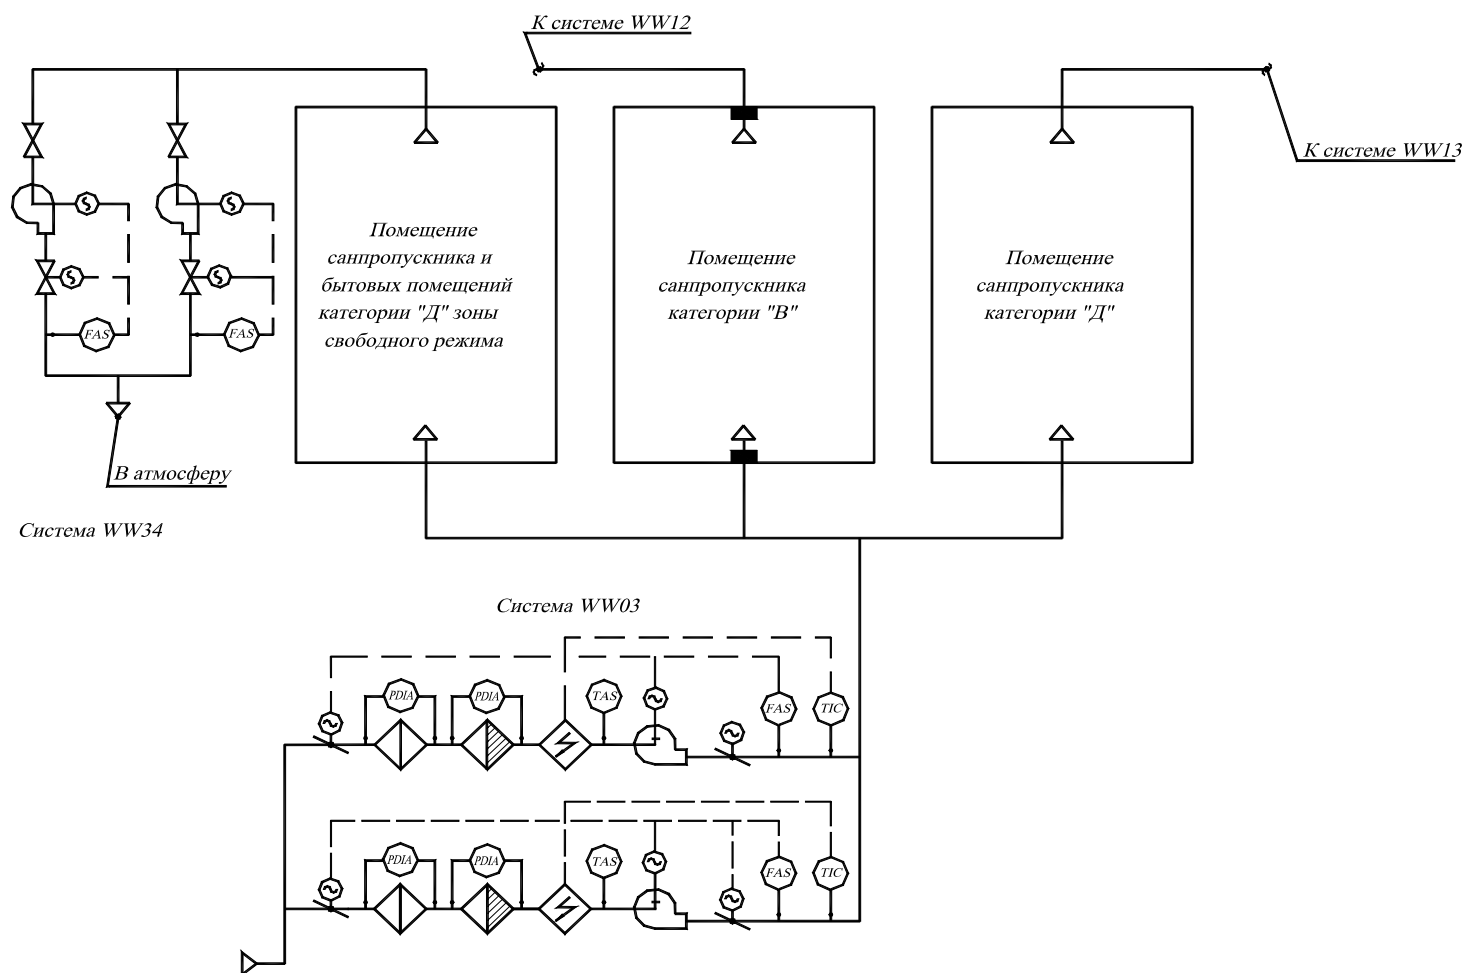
Принципиальная схема вентиляционной системы помещений санпропускника здания приемки
